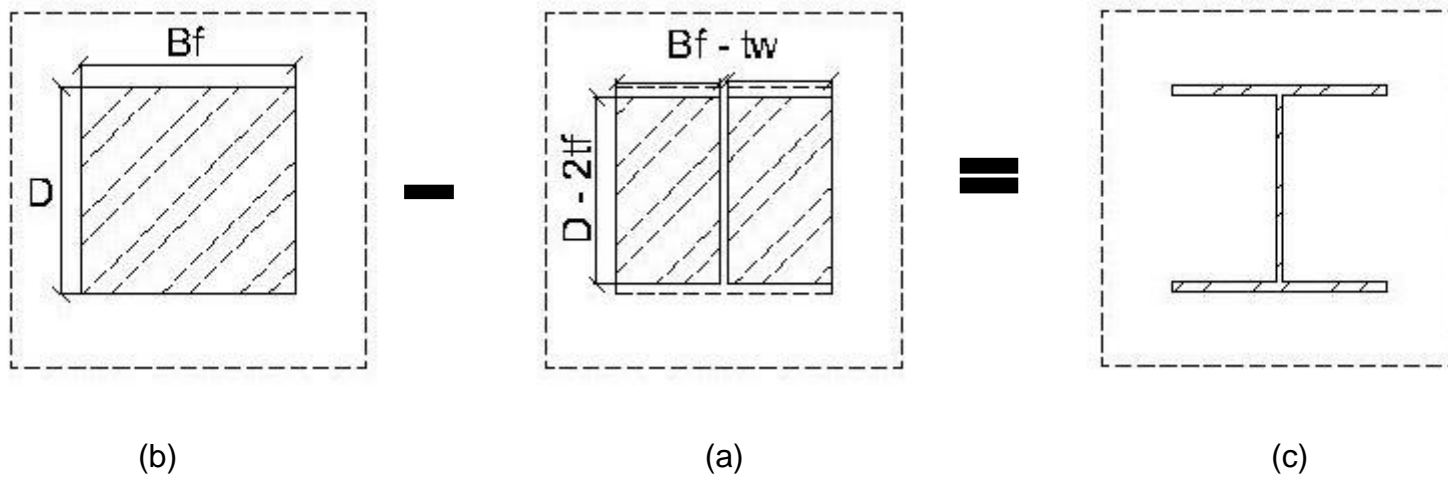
Suma y resta para espacio perfil W en sección rectangular concreto
